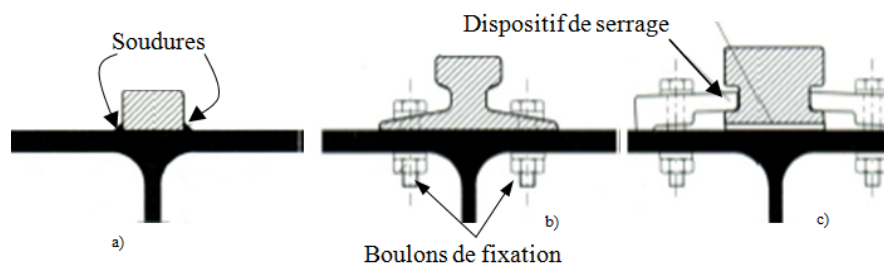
Modes de fixation des Rails sur la poutre de roulement ; a) Rail en fer plat soudé b) Rail à semelle large boulonnée c) Rail à rainures pincé
